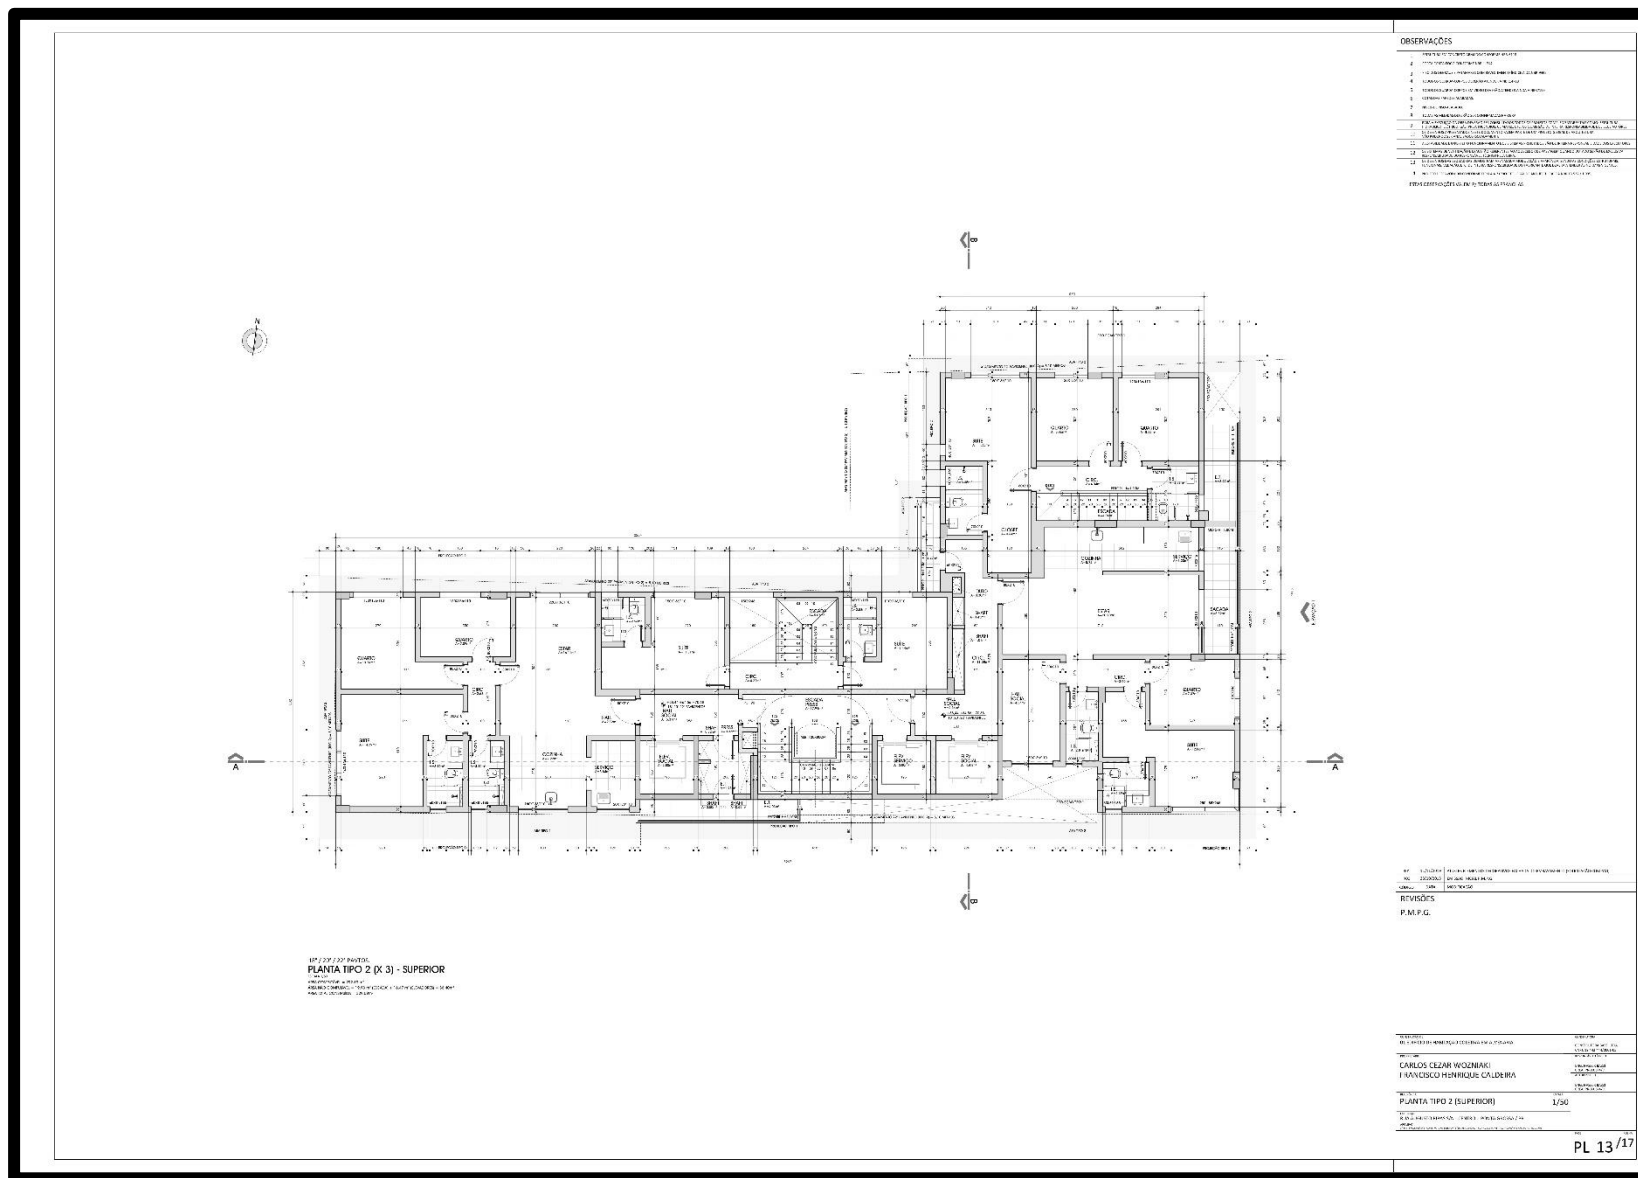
Planta pavimento tipo 2 superior (x3 – décimo oitavo, vigésimo, e vigésimo segundo pavimentos). Fonte: Construtora Bazzi (2020).
